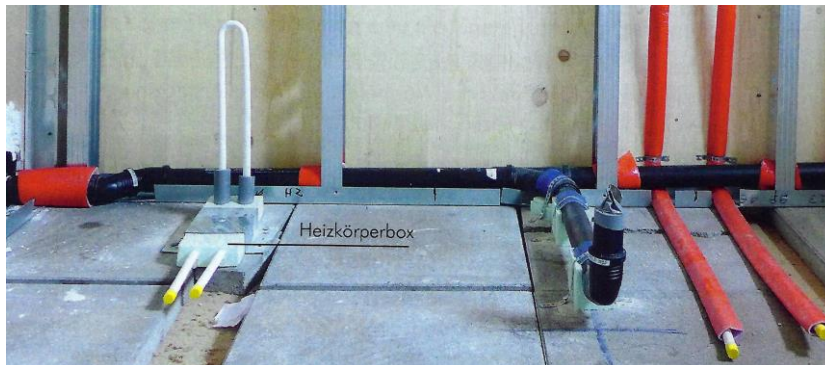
Installation von Heizungsrohren im Fußbodenaufbau und Heizkörperanschluss mittels Heizkörperbox<sup>109</sup>
